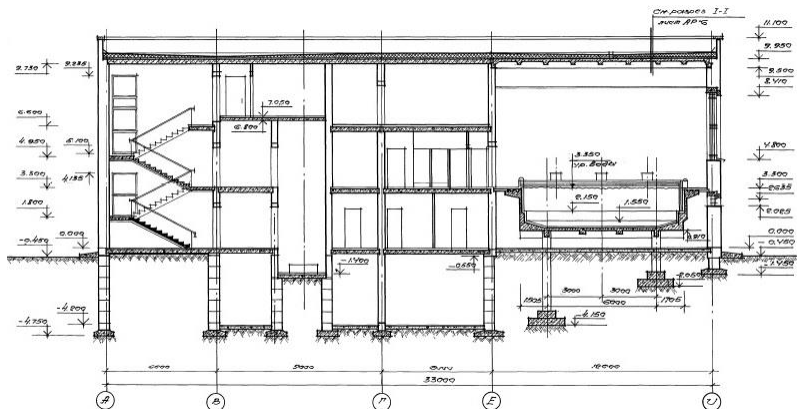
Разрез здания крытого бассейна, ТП 294-3-56.90
